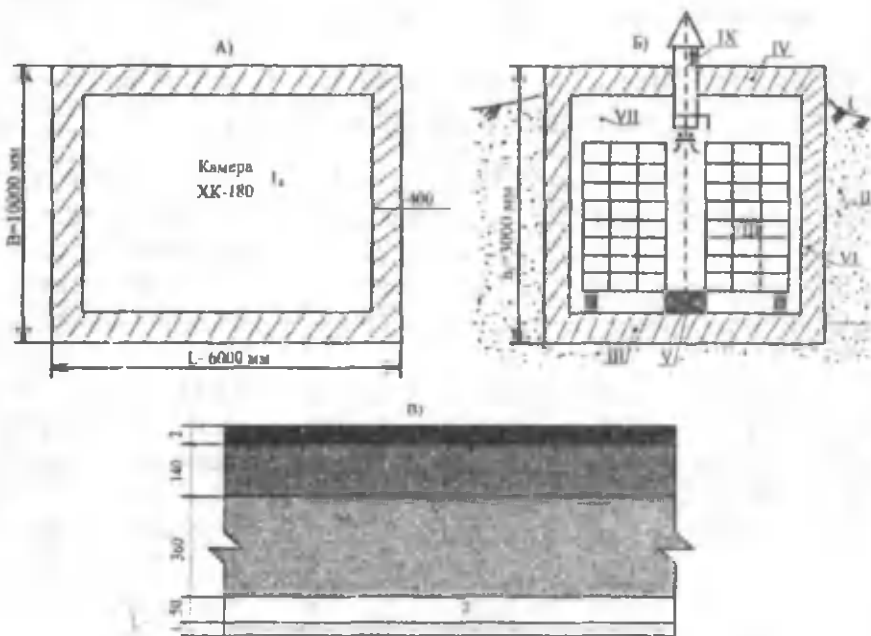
План (А) и поперечный разрез (Б) опытного углубленного плодовоовощехранилища ХК-180. I-поверхность земли; II-грунтовой массив; III-под, бетон толщиной $\delta=50$ мм; IV-кровля (В). состоит из: 1-прозрачного экрана ПВД $\delta=1$ мм; 2-воздушной прослойки $\delta_{вп}=50$ мм; 3-ж/б плиты (6х1, 2) – 8 штук, $\delta=360$ мм; 4-керамзитного слоя $\delta=140$ мм; 5-2 слоя рубероида $\delta=2$ мм на битумной мастике; V-приточный вентиляционный канал; VI-наружное ограждение $\delta=400$ мм, пенобетон; VII-охлаждаемое помещение; VIII-шпатель овощей; IX-вытяжной канал
